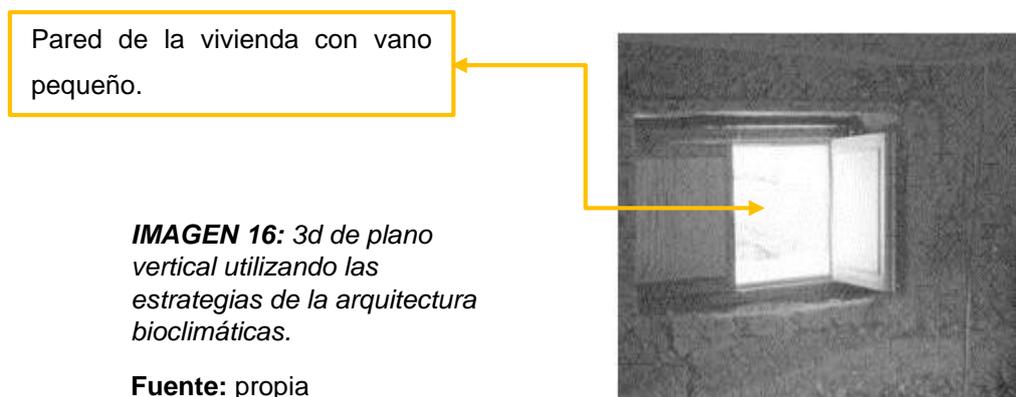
3d de plano vertical utilizando las estrategias de la arquitectura bioclimáticas.
